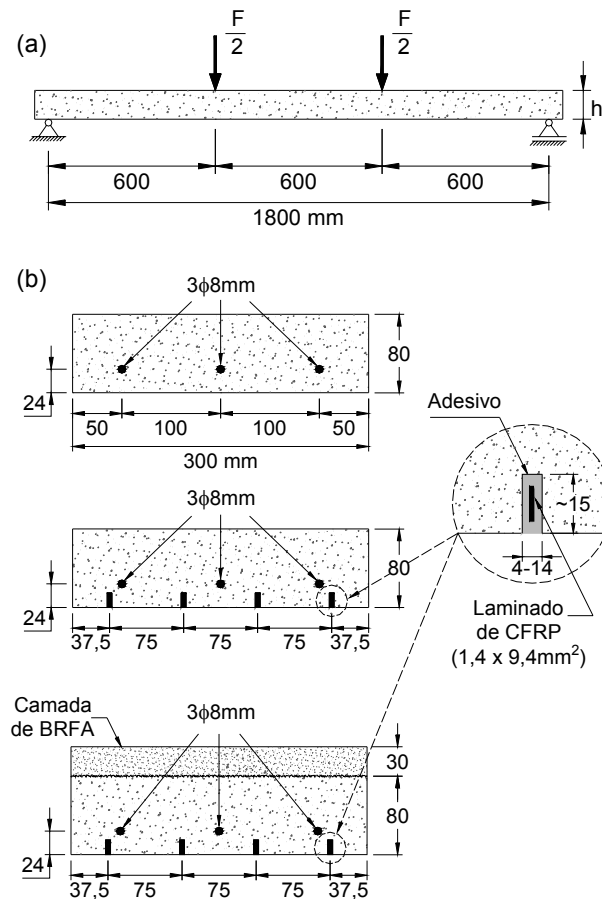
Geometria, carregamento e disposição das armaduras e dos laminados de CFRP (dimensões em mm)
